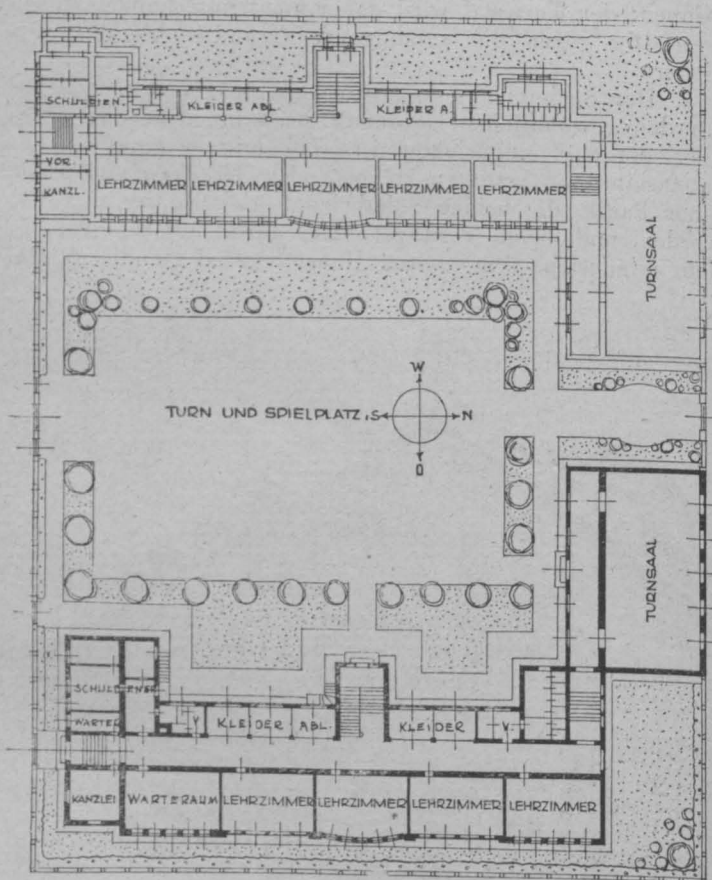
Volksschule XI. Kaiser-Ebersdorf. Erdgeschoß-Grundriß.
